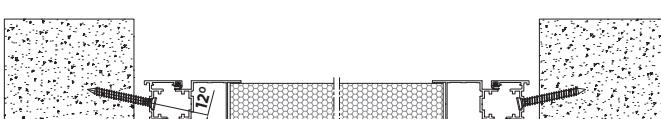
Montaggio su muro - telaio angolare - sezione orizzontale - porta a un'anta - sistema AW45.
